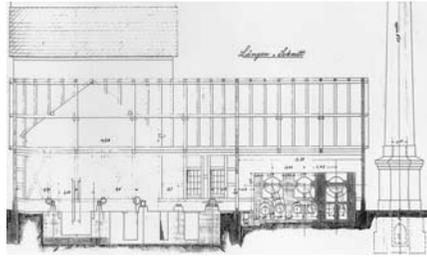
Kanekuhler Dampfkraftanlage. 1875. Bergarchiv Clausthal links das ursprüngliche Maschinenhaus mit (von links nach rechts) Fördermaschine, Wasserpumpenantrieb und Kompressor; hinter dem Maschinenhaus: das Schachthaus, rechts: die Dampfkesselanlage mit dem ursprünglichen Schornstein
